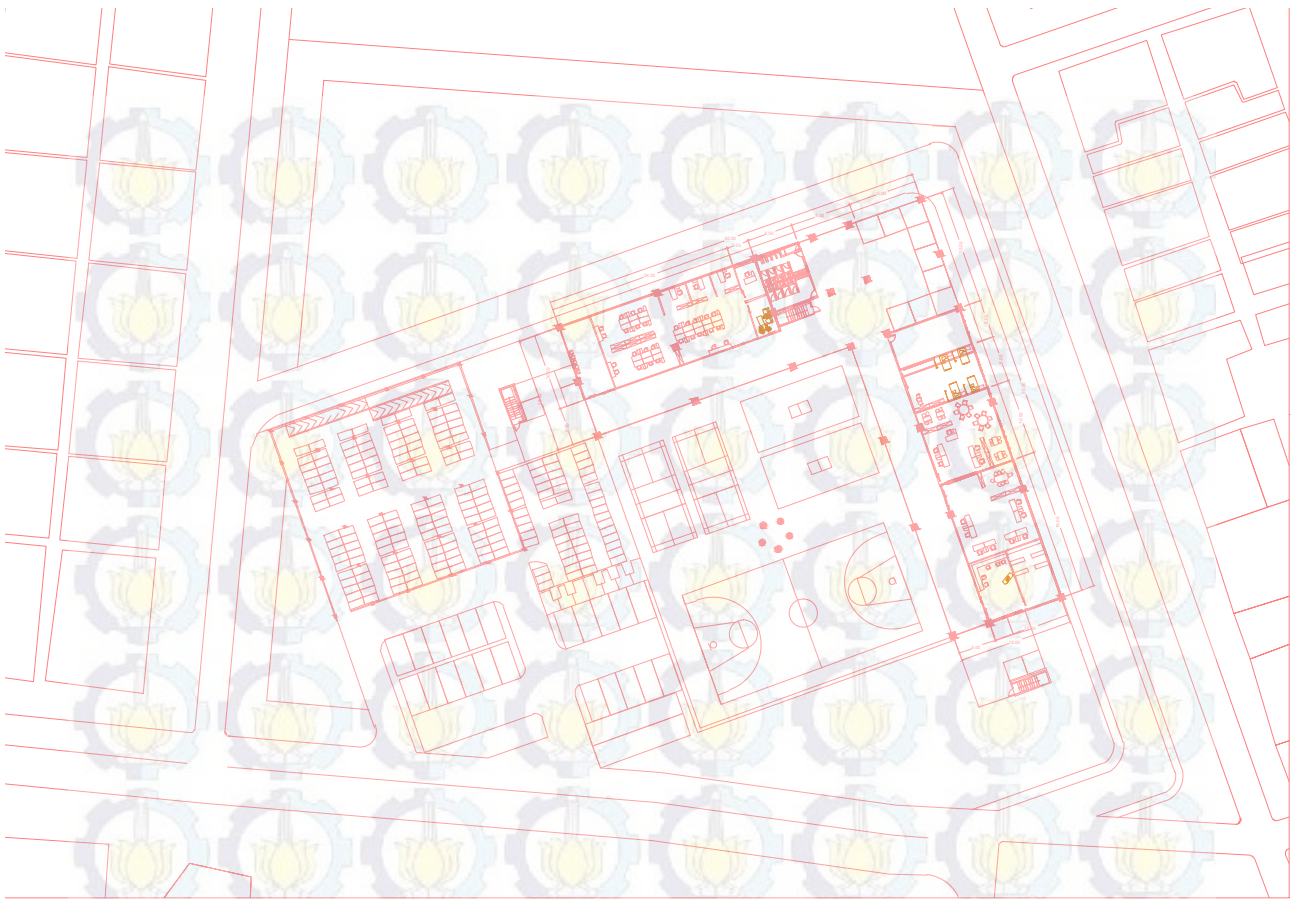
Perkembangan rancangan *lay out plan
